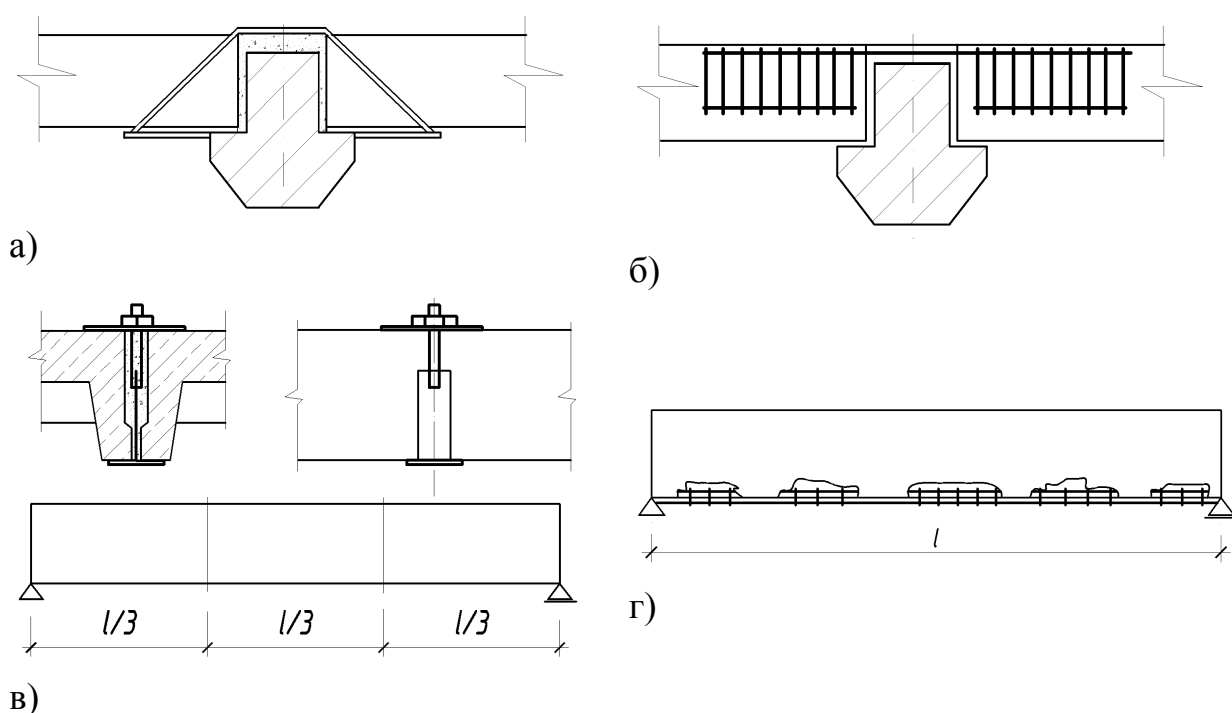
Підсилення плит: а – кронштейнами; б – введення опорного арматурного каркасу; в – передача навантаження на сусідні плити; г – нарощування розтягнутої зони перерізу
